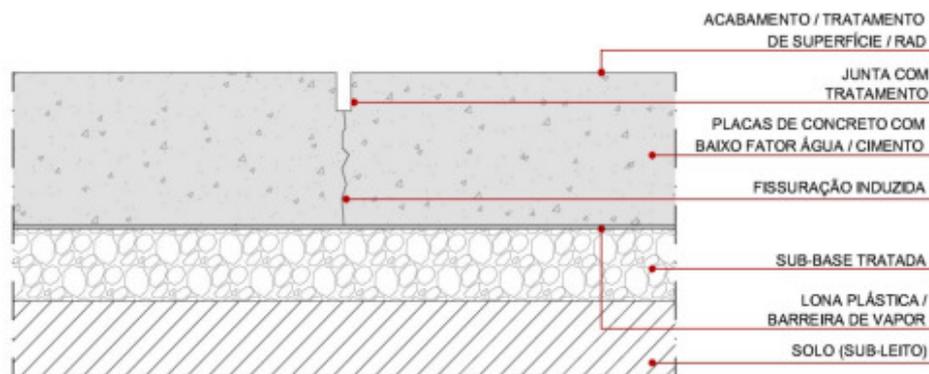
Pavimento de concreto simples sem barra de transferência
